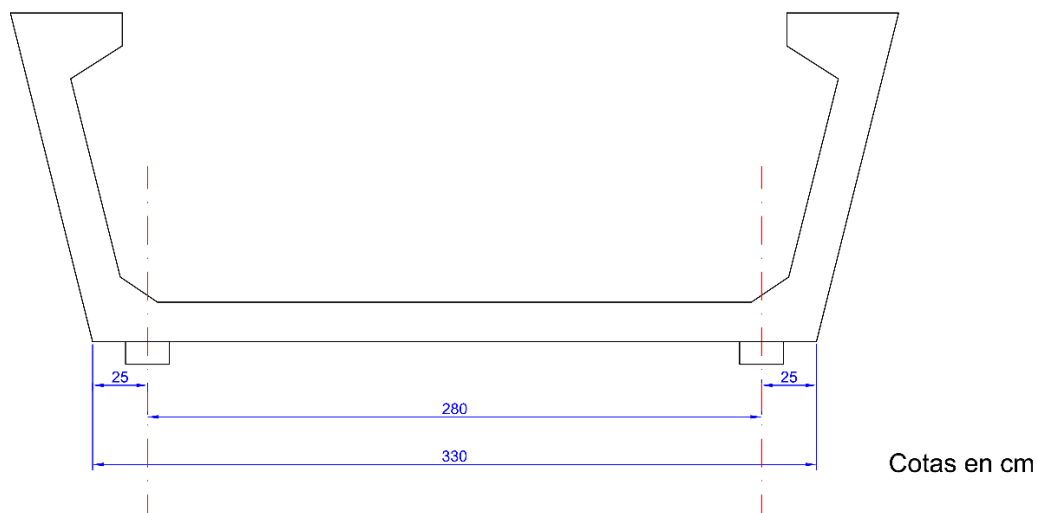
Croquis detalle de la ubicación de los apoyos
